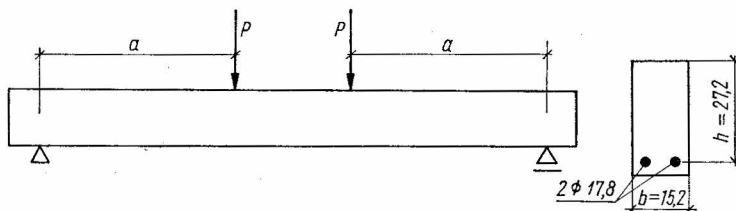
Exemple d'une poutre en béton armé dans les essais de KANI
